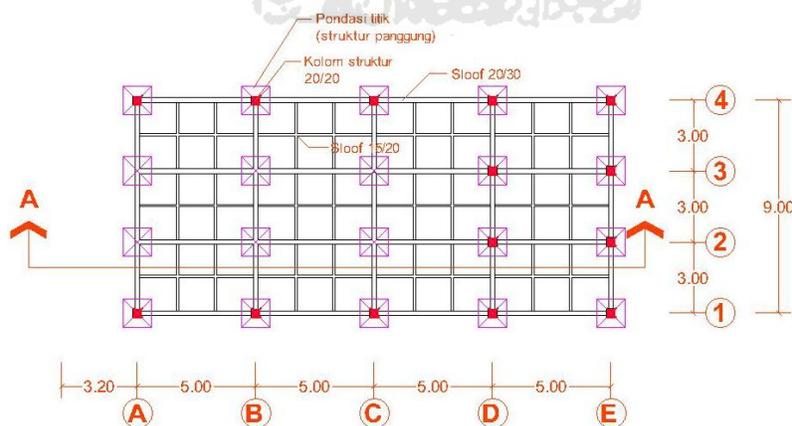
Rencana Pondasi Restoran dan Lounge
